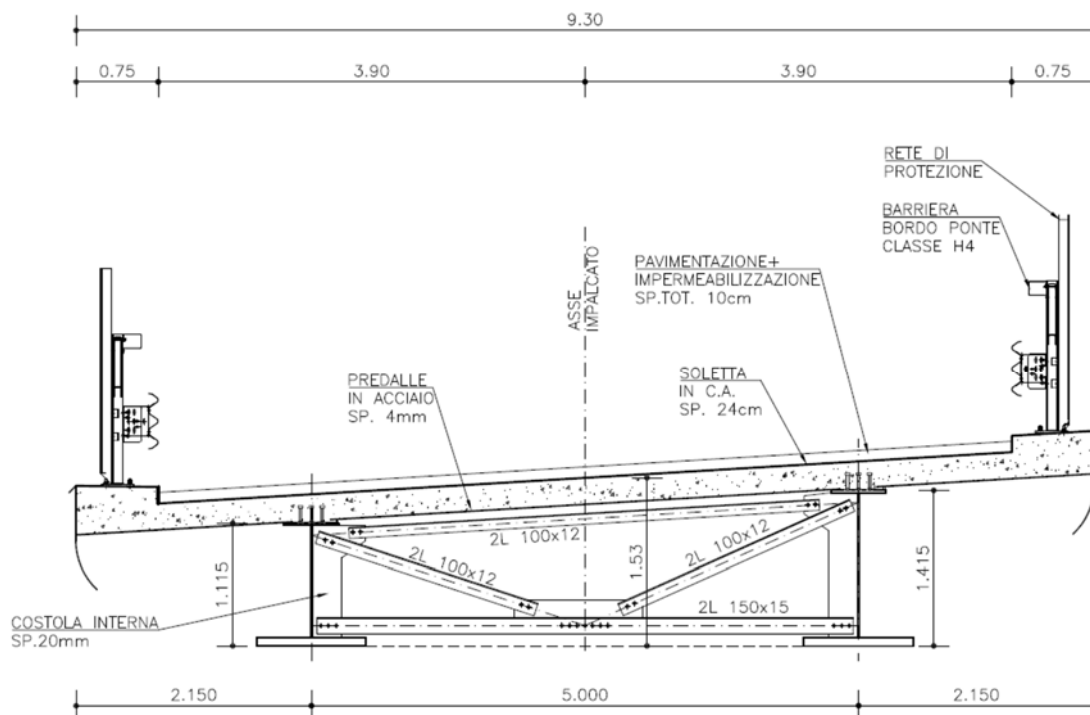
Sovrappasso di ingresso – sezione trasversale tipo dell'impalcato
